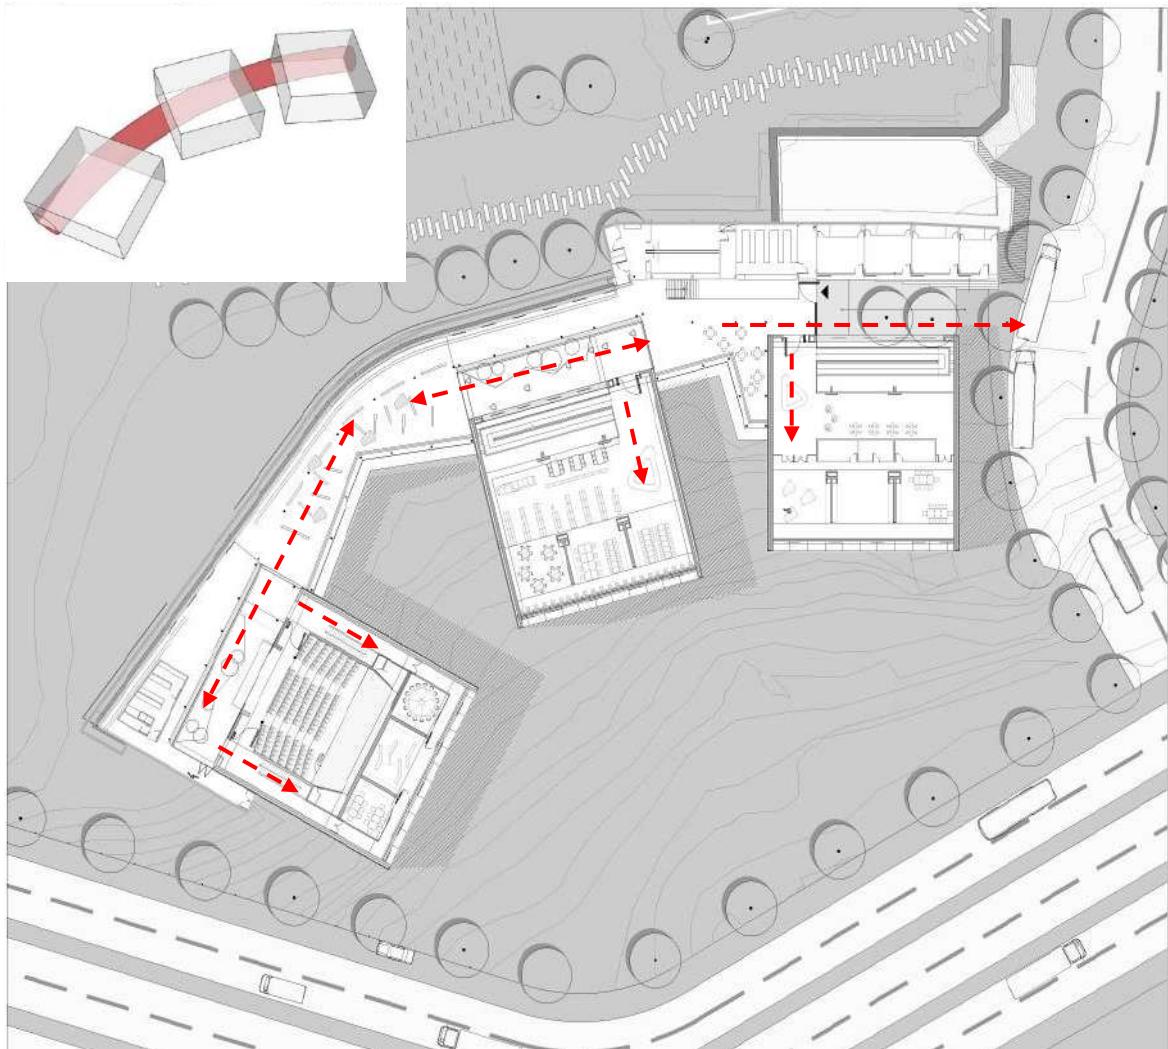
Parque Biblioteca León de Grieff / Planta
